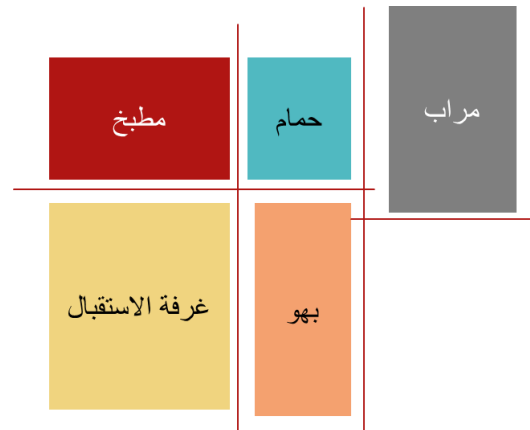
مخطط الطابق الأرضي لمشروع 8 فيلا بسكرة
